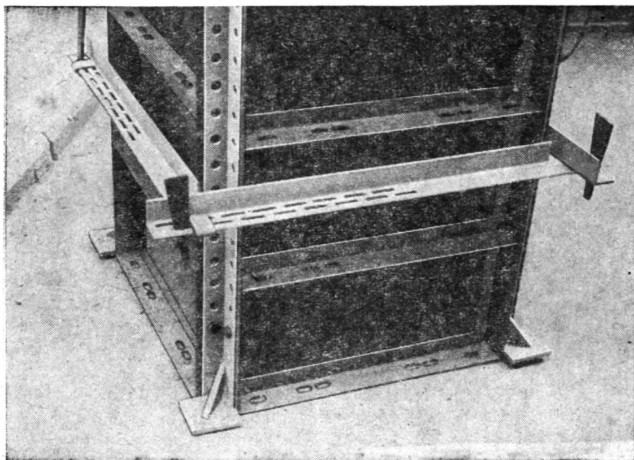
Четырехветвевой хомут для крепления опалубки колонн
